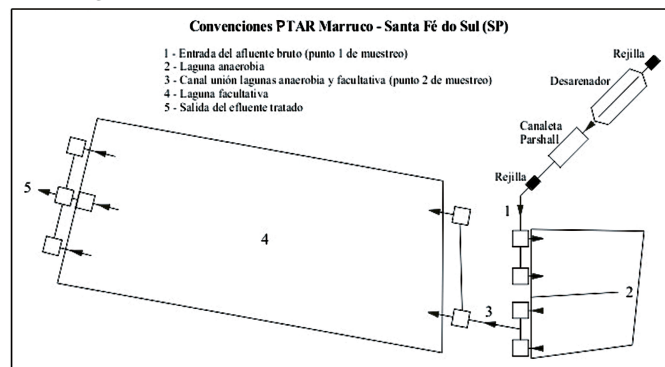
Vista en planta de la PTAR de Santa Fé do Sul con los puntos de muestreo.
